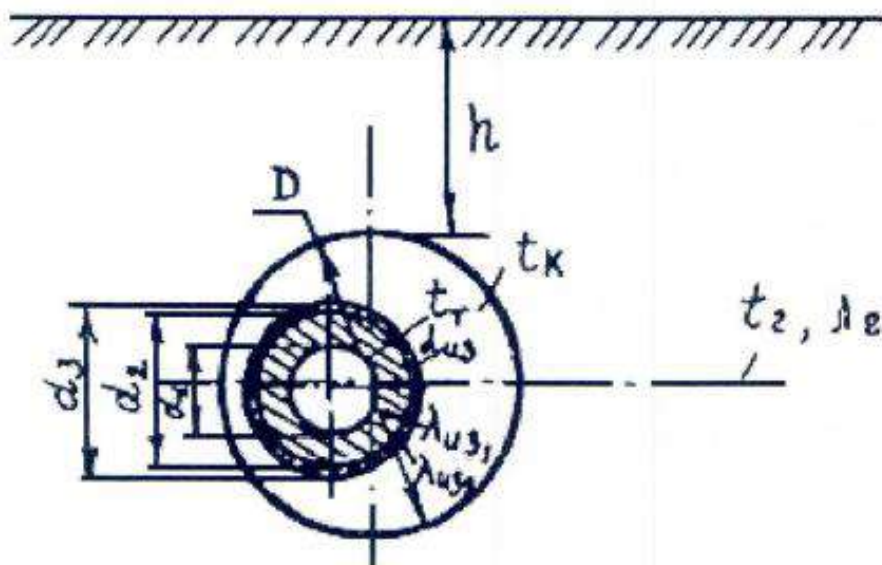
Расчетная схема рабочего трубопровода в защитном футляре (кожухе) при пересечении земляного полотна
